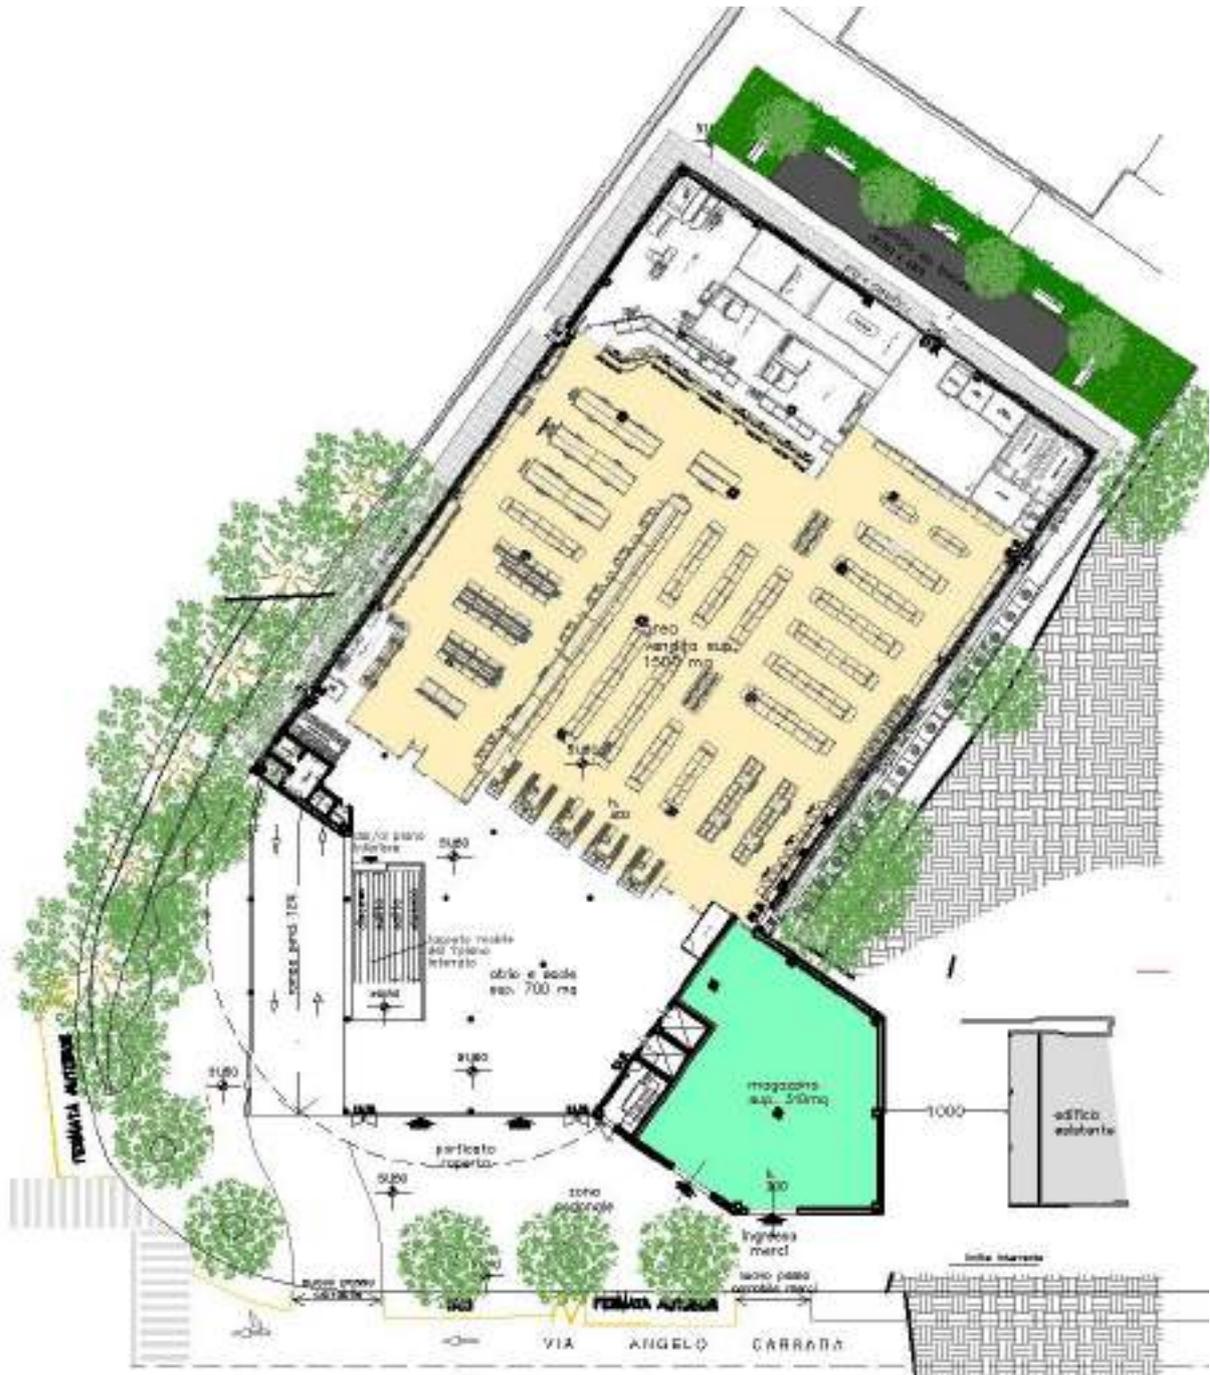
Pianta piano terra di progetto, in giallo la MSV, 1500 mq.
